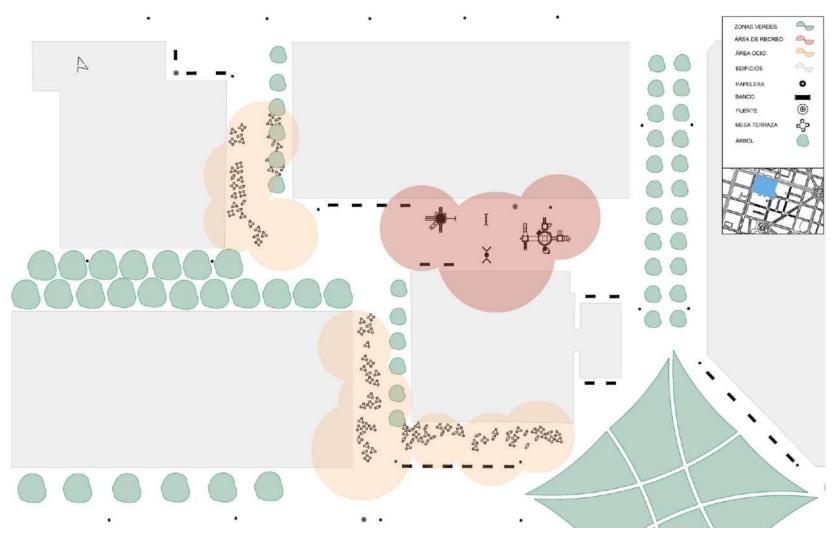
Plano de detalle 1. Escala 1:500 (A3).
